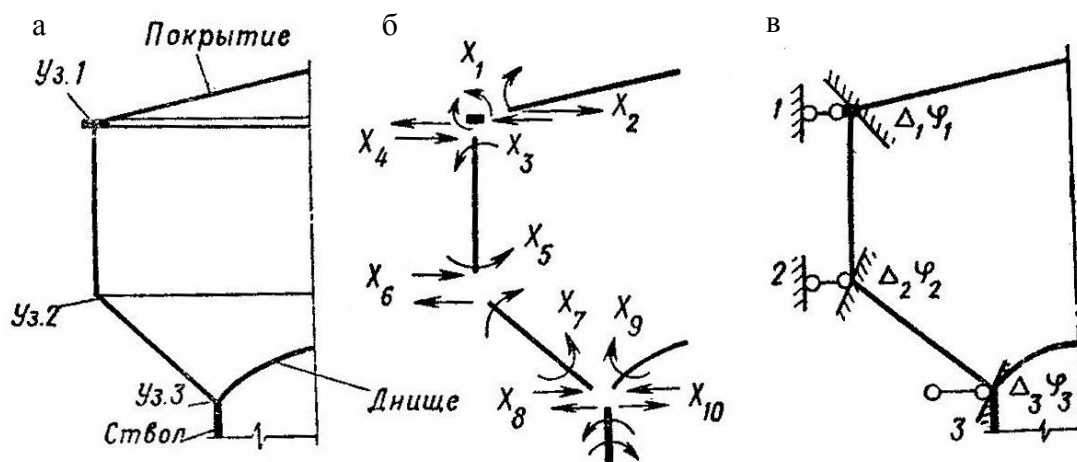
К расчету резервуара водонапорной башни:
